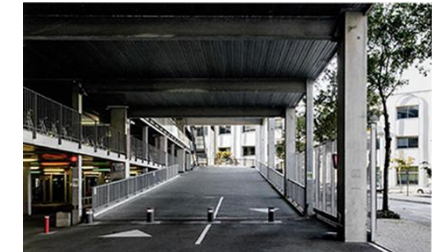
Acceso rodado-arranque rampa, ENSAN.
